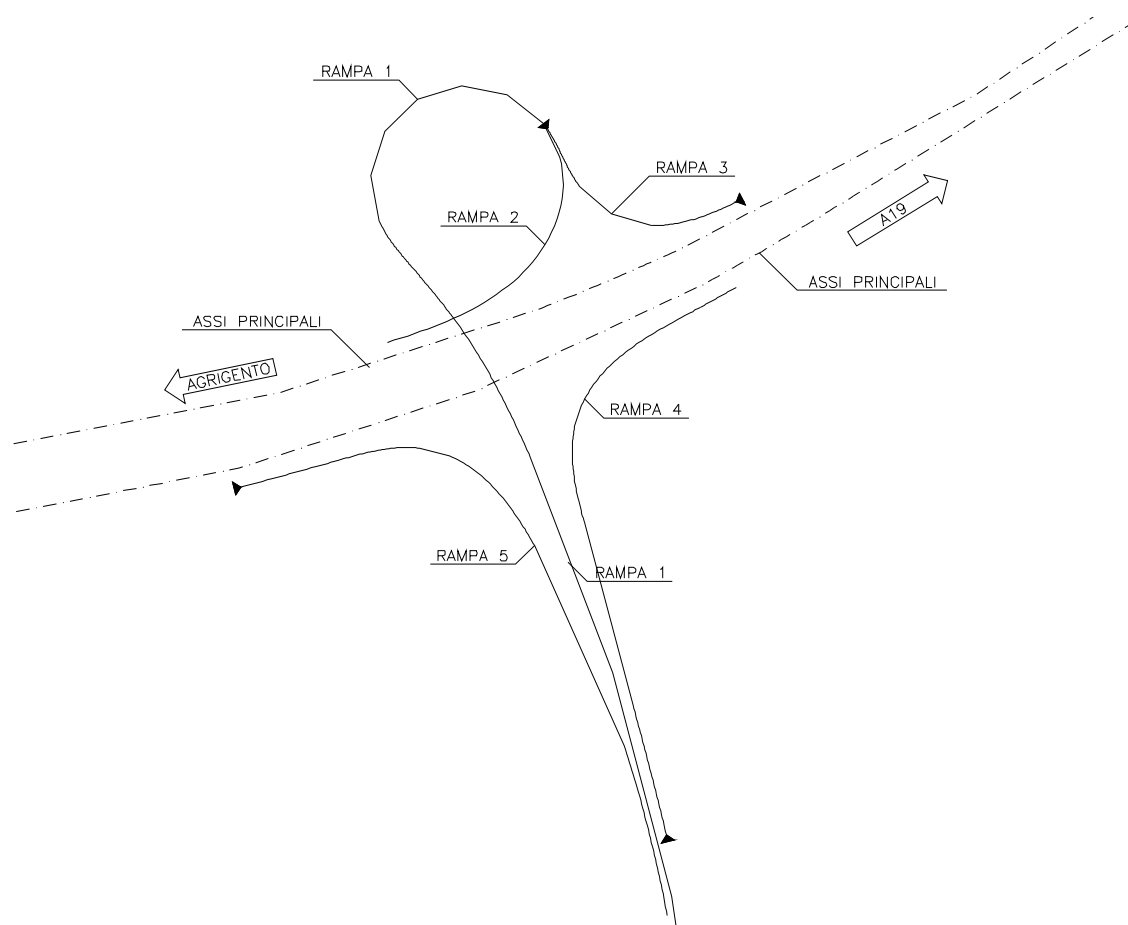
Svincolo SS 626- Planimetria schematica
